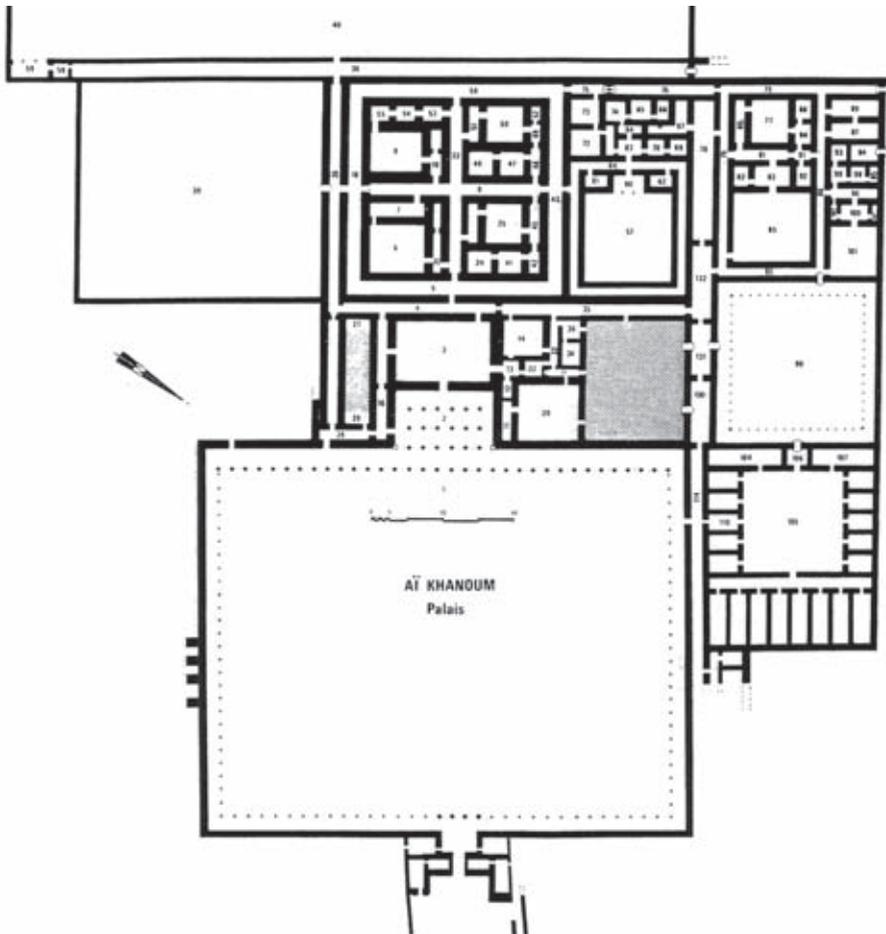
Ai Khanoum. Palacio. Planta (de Bernard, 1981)
